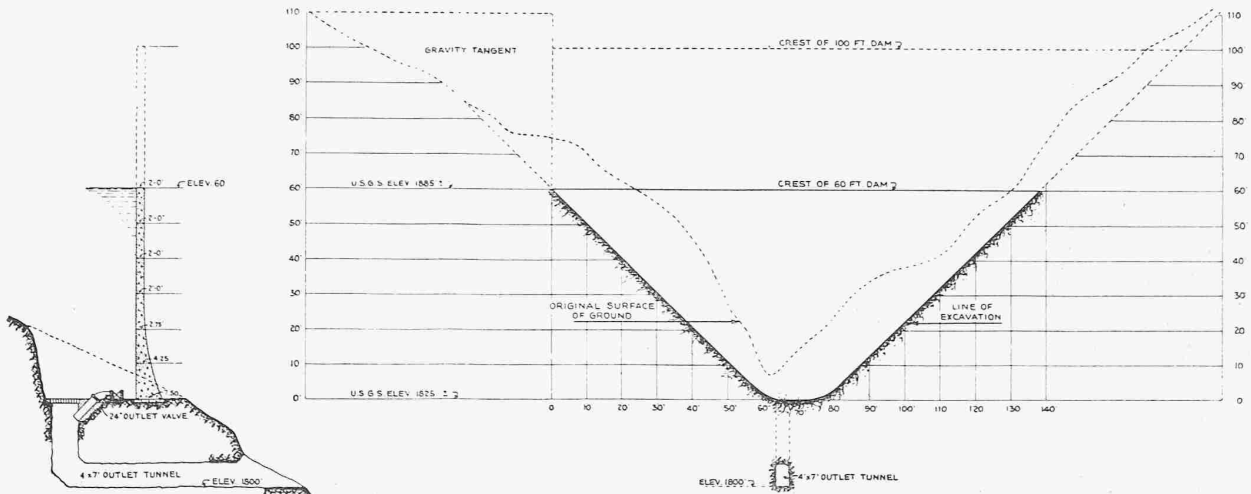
Grundriss, Aufriss und Schnitt 1 : 600 der Versuchs-Gewölbe-Staumauer am Stevenson-Creek, Californien.
